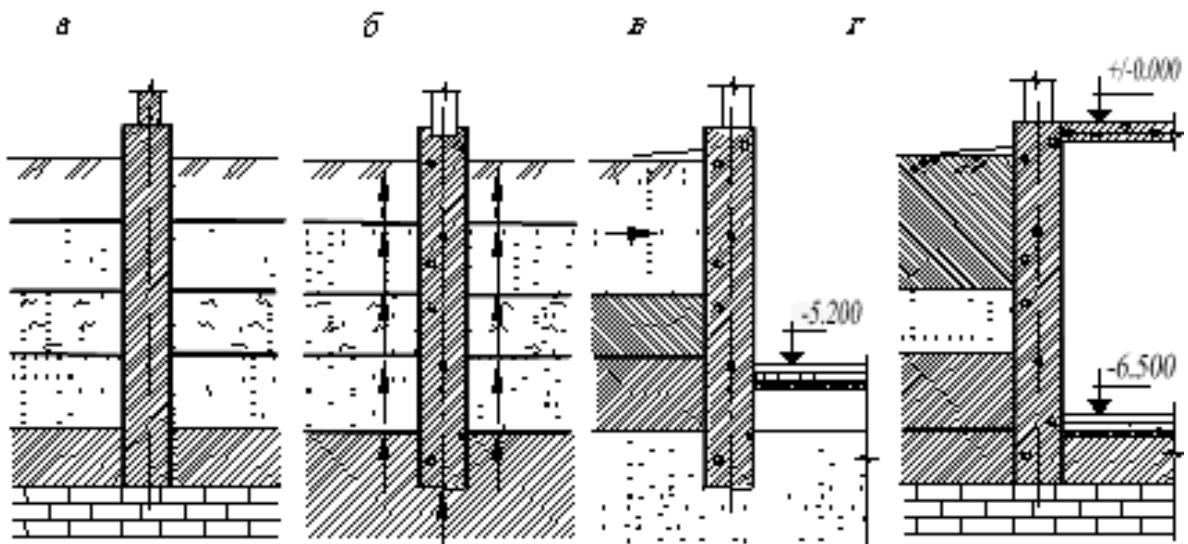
Схемы поперечных разрезов шлицевых фундаментов: *а* – работающие нижней частью; *б* – работающие нижней частью и боковой поверхностью; *в* – работающие консольно; *г* – работающие с элементами жесткости – перекрытие, защемление
